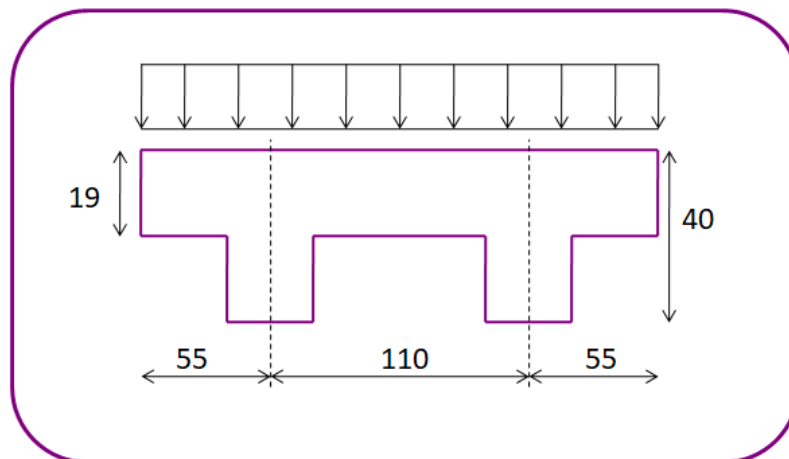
schéma statique de palier de repos d'un escalier sur limon central.
